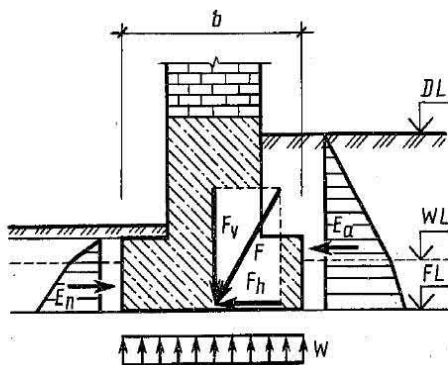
Схема к расчету фундамента на плоский сдвиг
